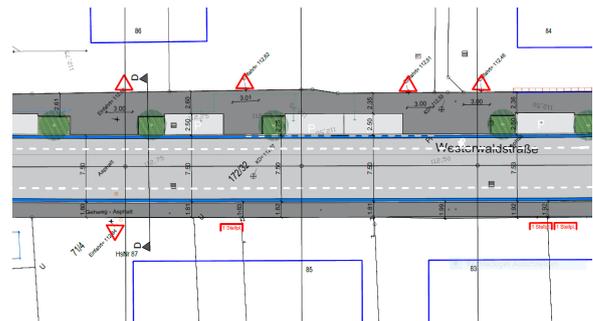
Ausschnitt Planung Westerwaldstraße 2 BA; *Quelle: Stadt Limburg
